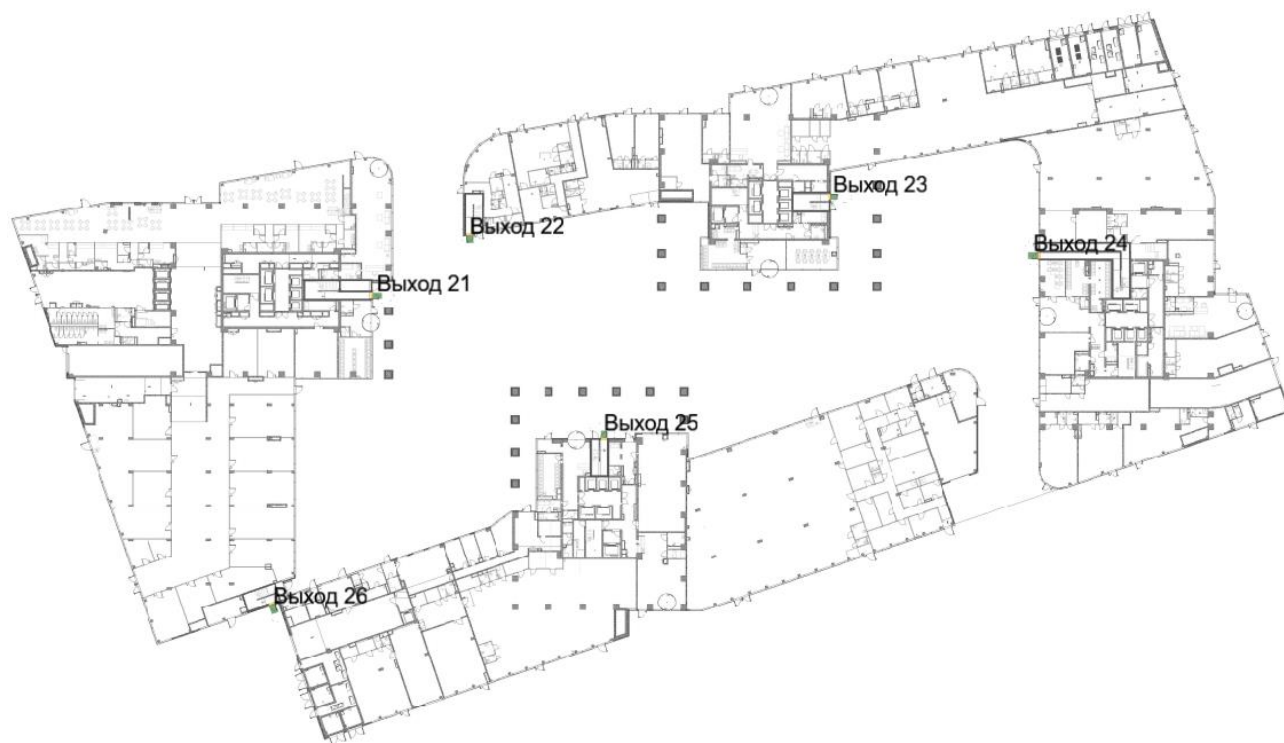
План 1-го этажа и нанесенная на него расчетная (принципиальная) схема эвакуации
